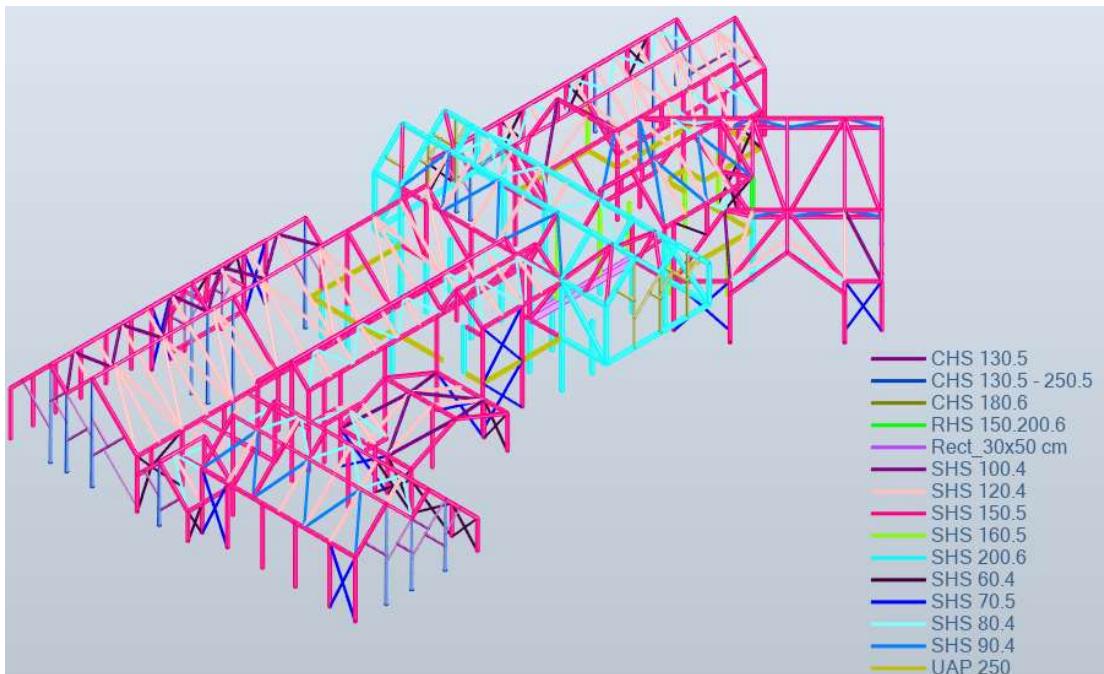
Vista general 3D de la estructura e indicación de perfiles. Vista desde fachada principal
